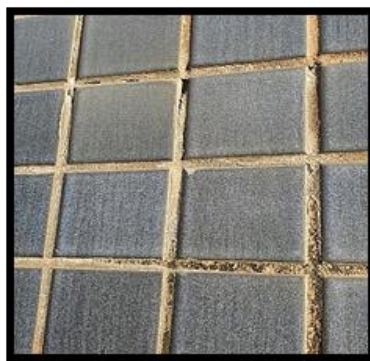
Fissuras em sistema de revestimento cerâmico.
